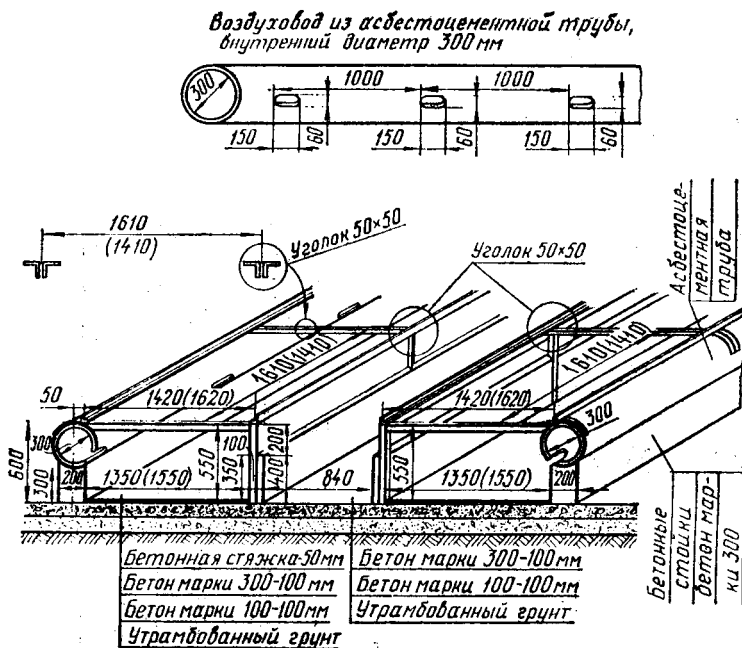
Элементы внутреннего оборудования в крольчатнике при реконструкции (оборудование траншей для тросово-скребкового транспортера по удалению навоза, воздуховодов вытяжной принудительной вентиляции, оборудование для установки клеточных батарей).
